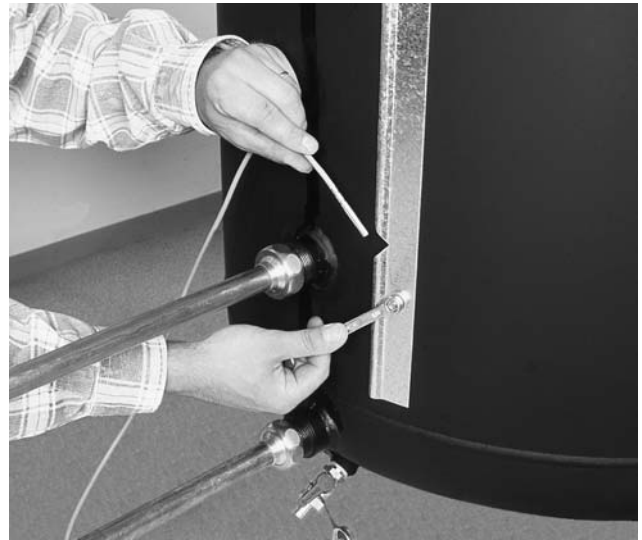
Temperaturfühler für Solarregler unter der Klemmleiste am Speicher festschrauben (Positionen s. Tabelle 1). Fühler für die Nachheizung in Tauchhülse am Flansch stecken. Auf guten Kontakt achten.
